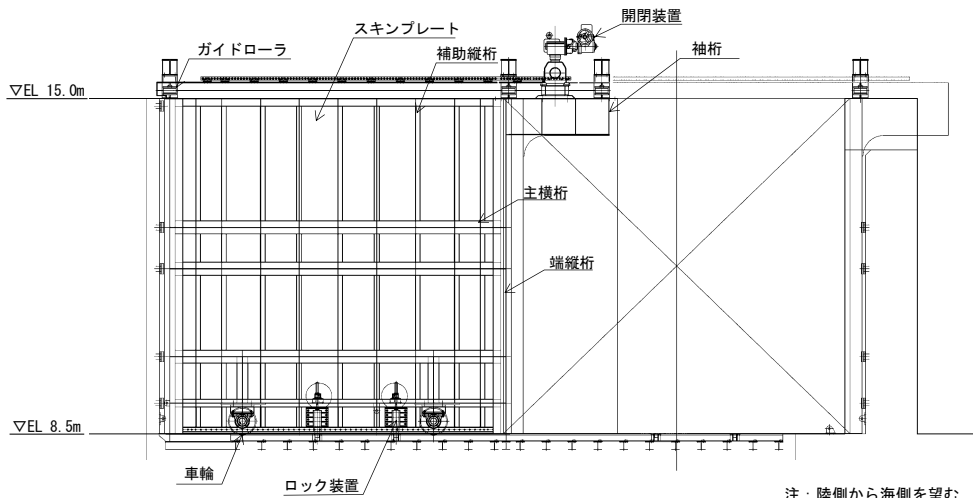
(3) 防波扉 (荷揚場南) の構造概要図 (断面図)
